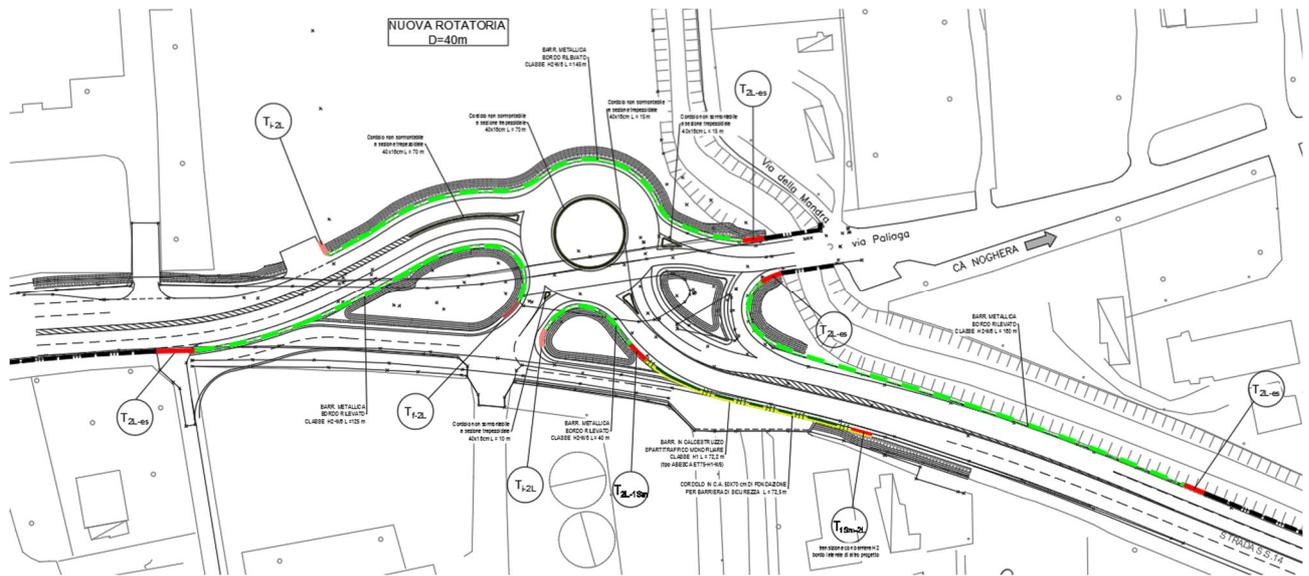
Planimetria barriere di sicurezza di progetto
